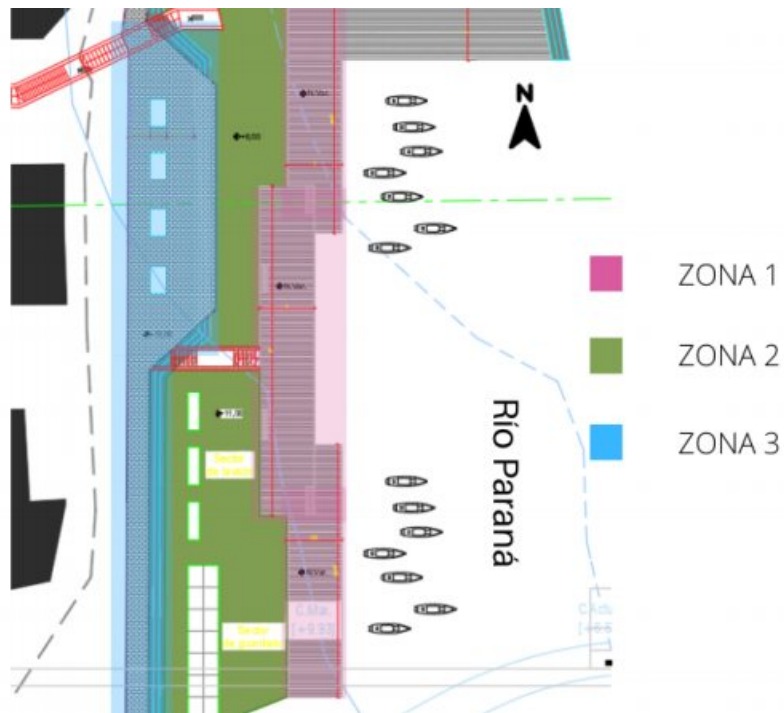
Zonas a intervenir en planta. Fuente: elaboración propia.
